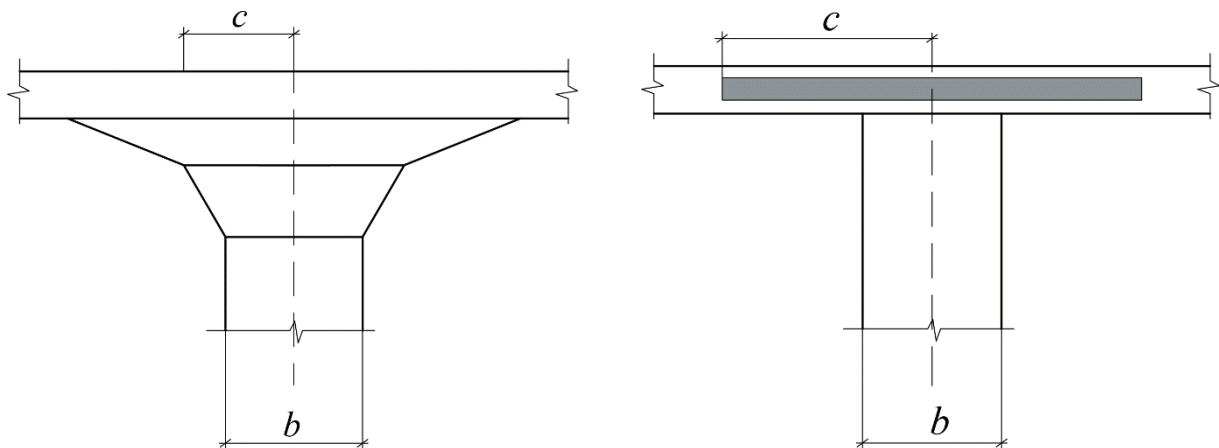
Капители безбалочных перекрытий: ломаного очертания (а) и скрытая (б)
